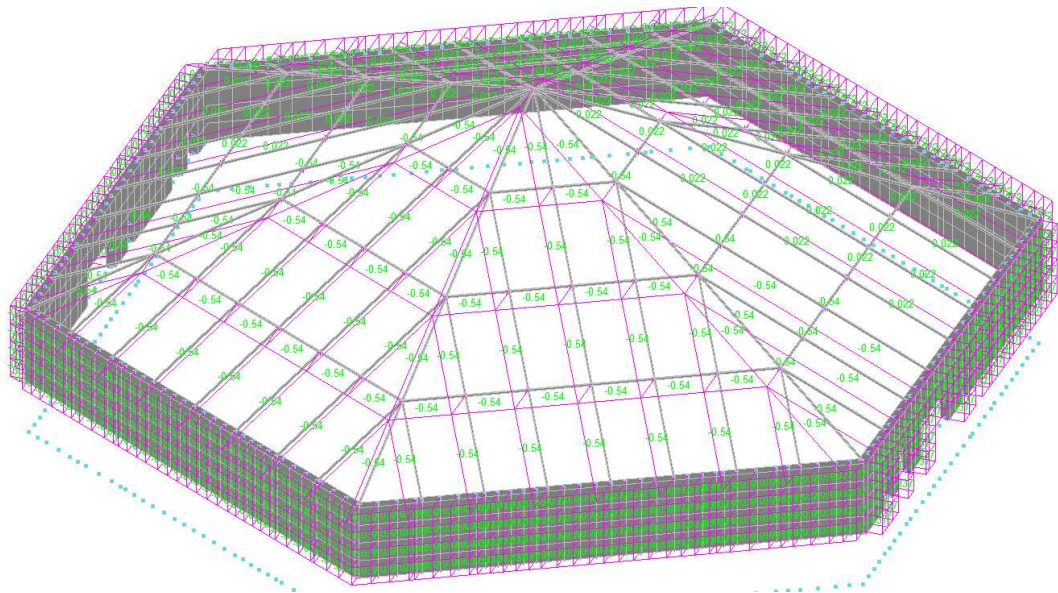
Схема приложения ветровой нагрузки по +Y
